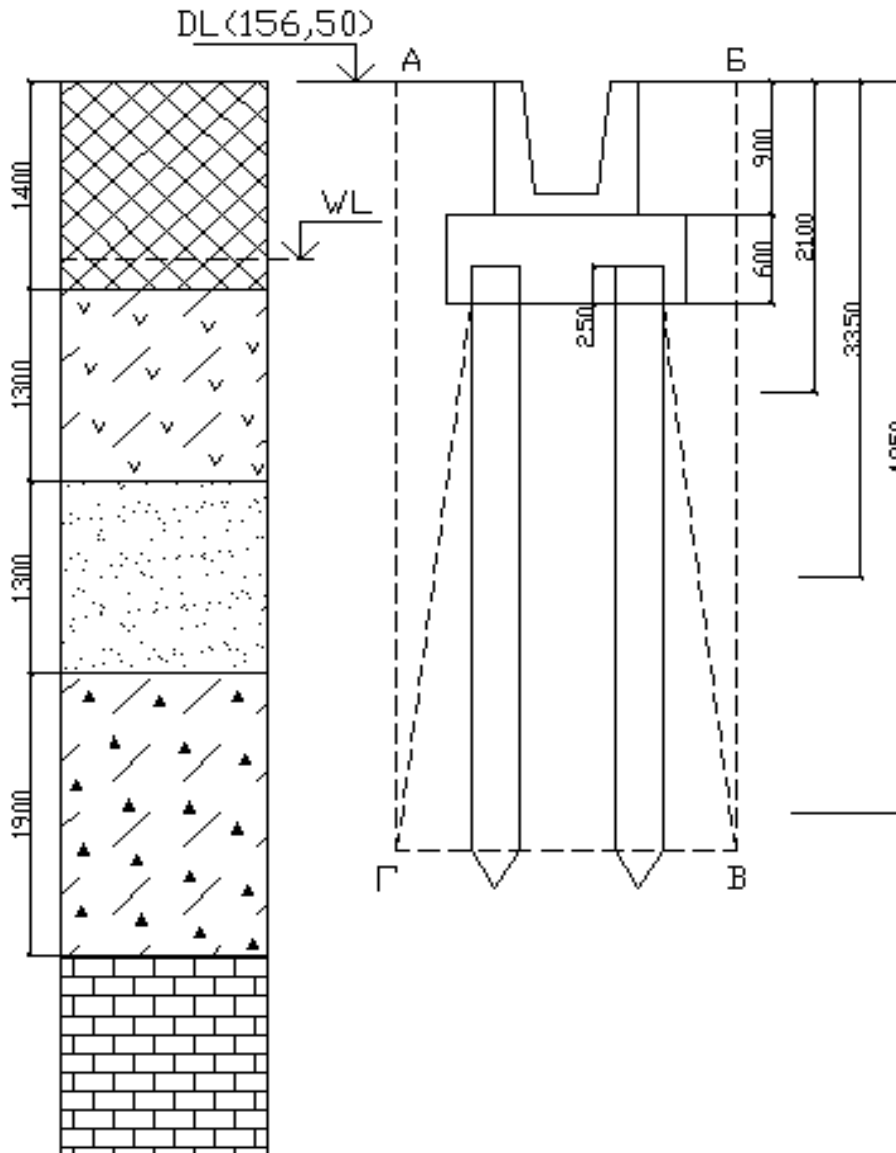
Розрахункова схема пальового фундаменту
